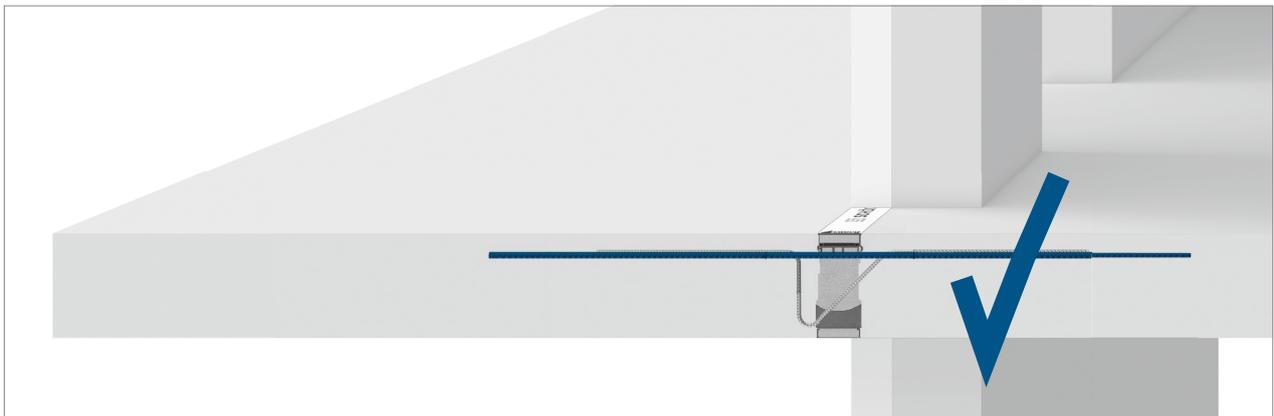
Schöck Isokorb® T Typ KL richtiger Einbau: Zugstab oben
